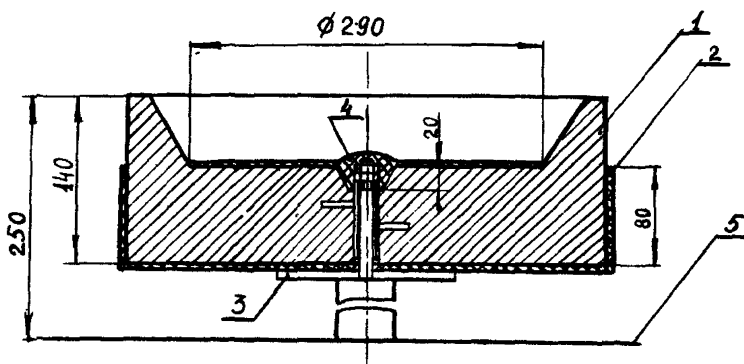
Схема установки протектора ПРМ-20 на днище резервуара: 1 — протектор; 2 — изоляционный экран; 3 — узел крепления; 4 — гайка; 5 — днище резервуара
